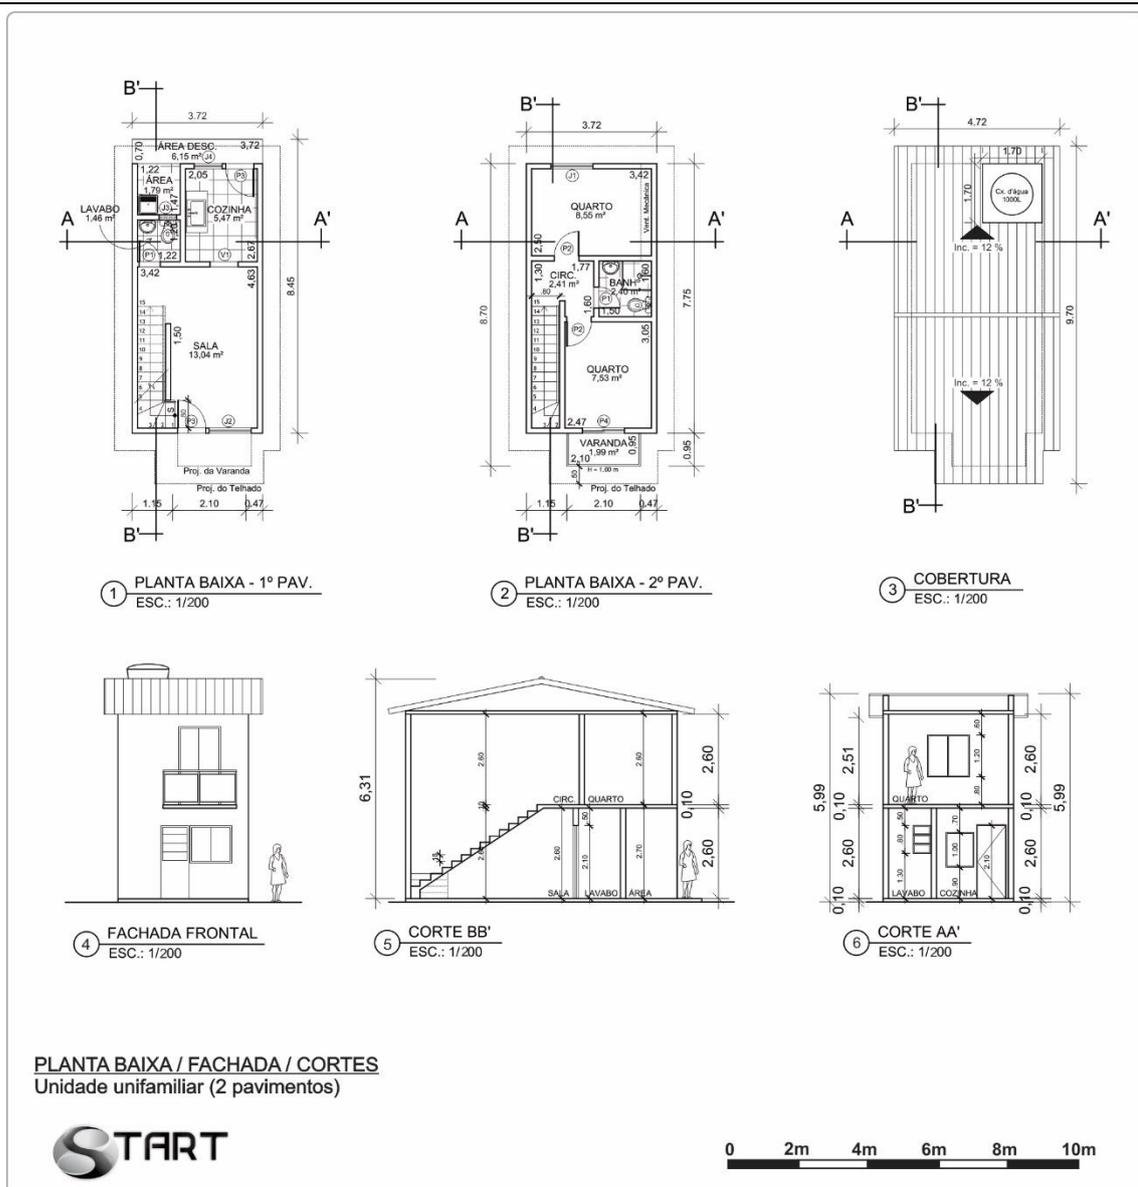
Planta baixa, fachada e cortes da unidade unifamiliar de 2 pavimentos
